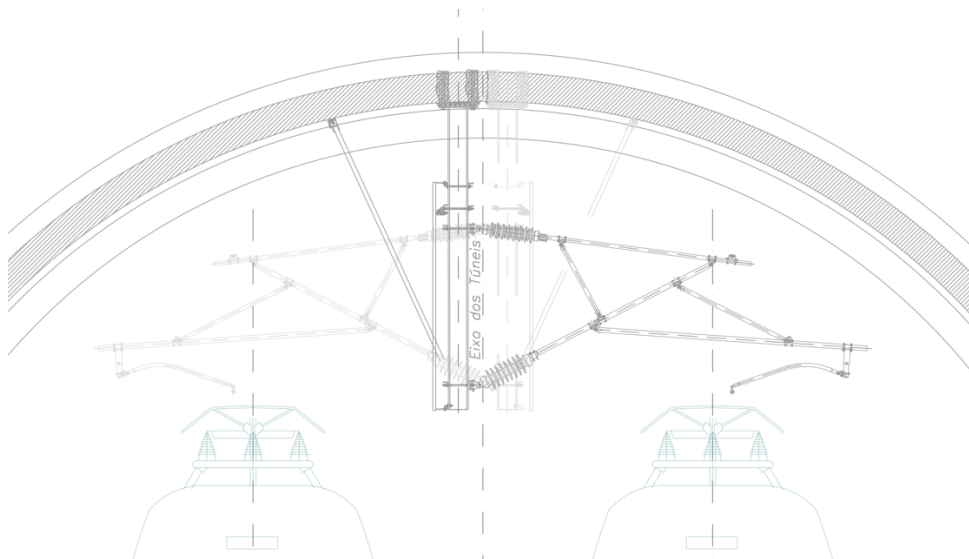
Detalhe de uma secção de túnel com o postaleta fixado à parte superior e duas consolas LP300.
